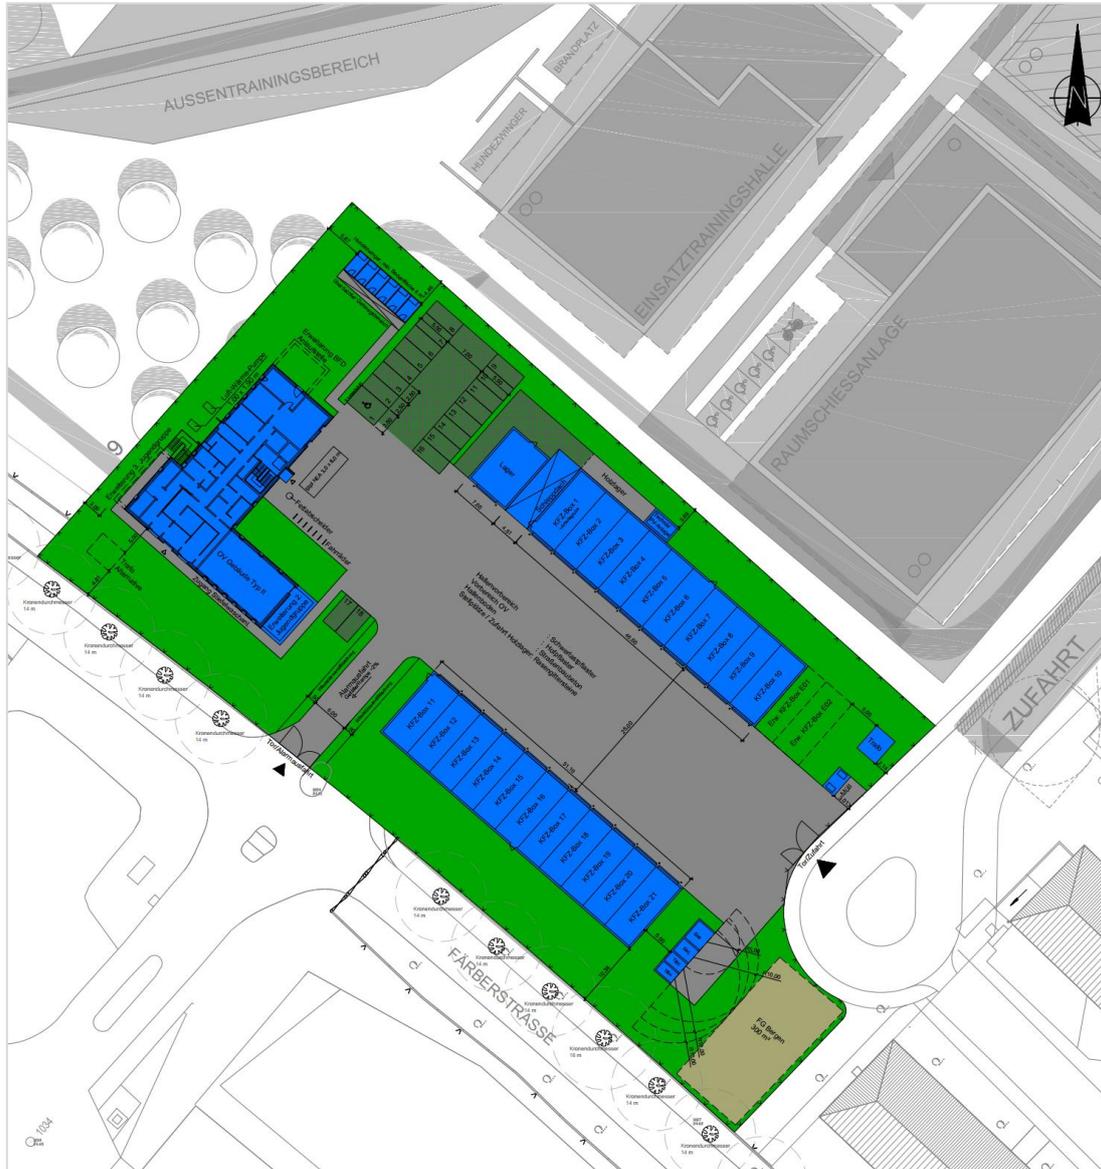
Lageplan Neubau THW OV Gebäude Typ mit Kfz-Hallen Neumünster (Stand:04.07.2023)
